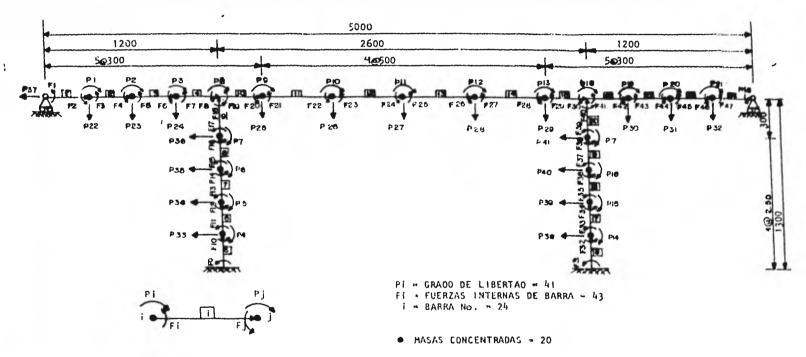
DIAGRAMA DE GIROS Y DESPLAZAMIENTOS CONTRA FUERZAS INTERNAS DE BARRAS PARA LA OBTENCION DE LA MATRIZ DE RIGIDECES GLOBAL DE LA ESTRUCTURA.
